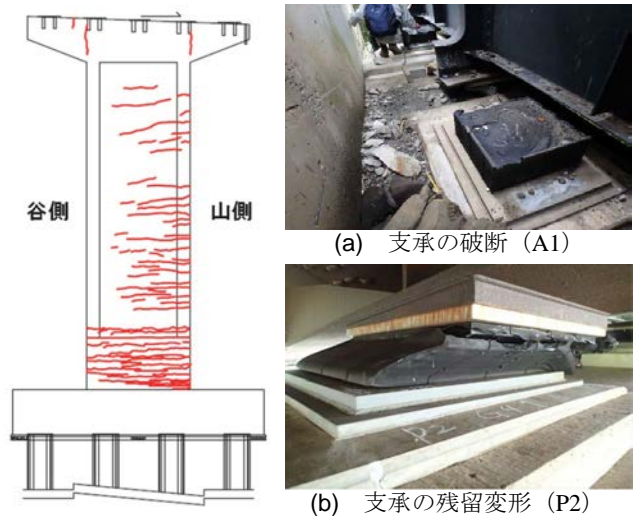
P2 橋脚ひび割れ¹⁵⁾
